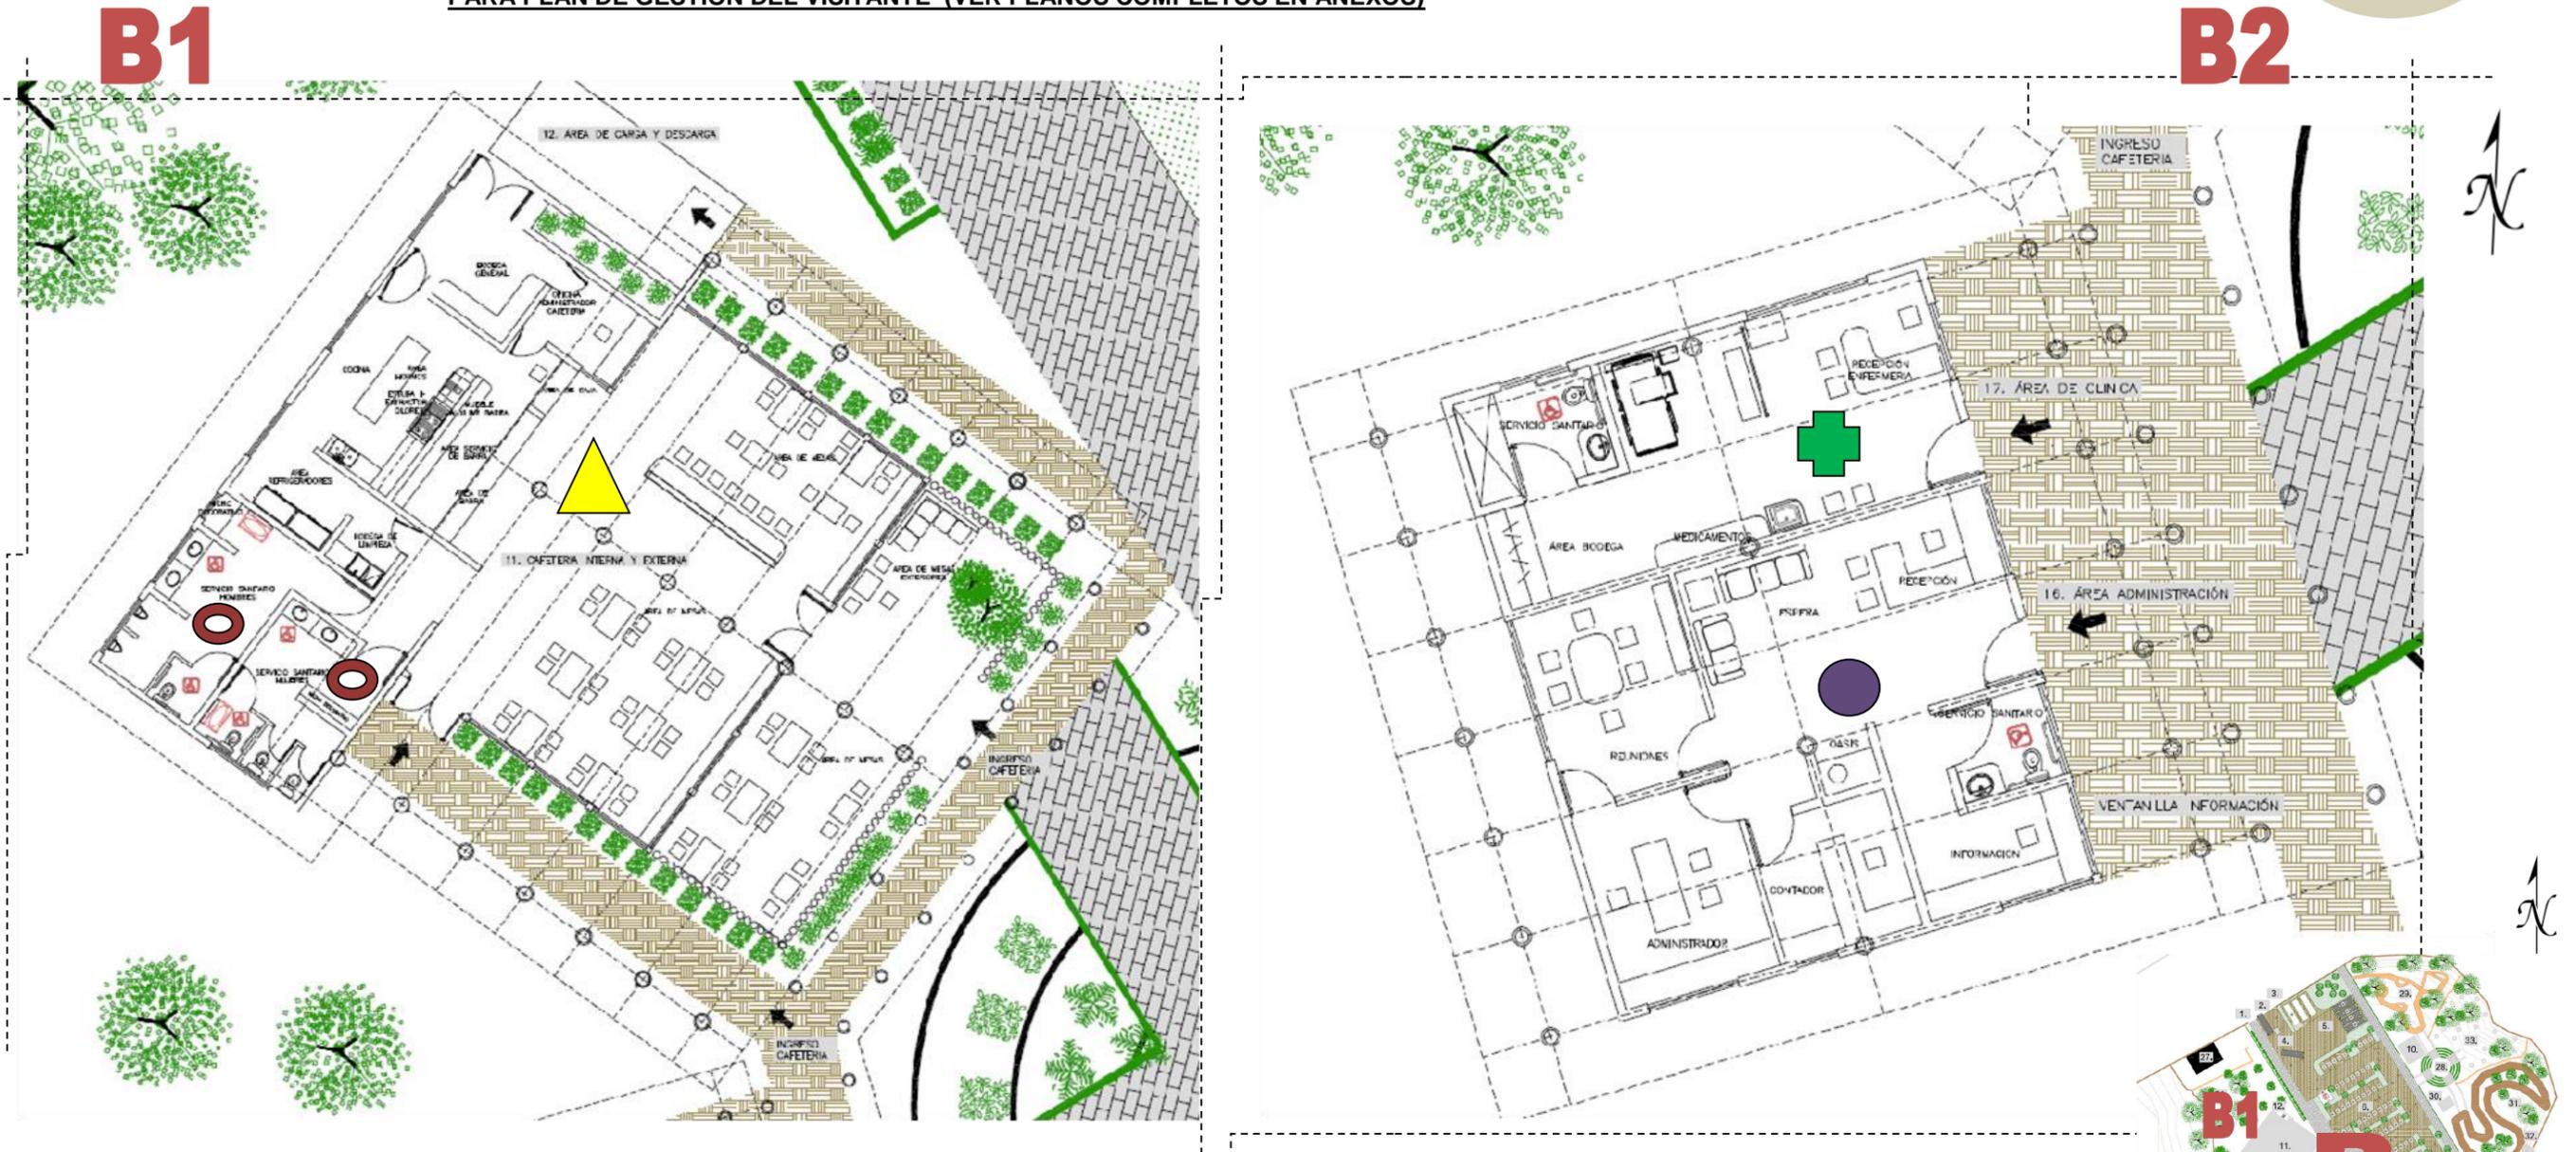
Planta Propuesta de área de servicios al visitante
